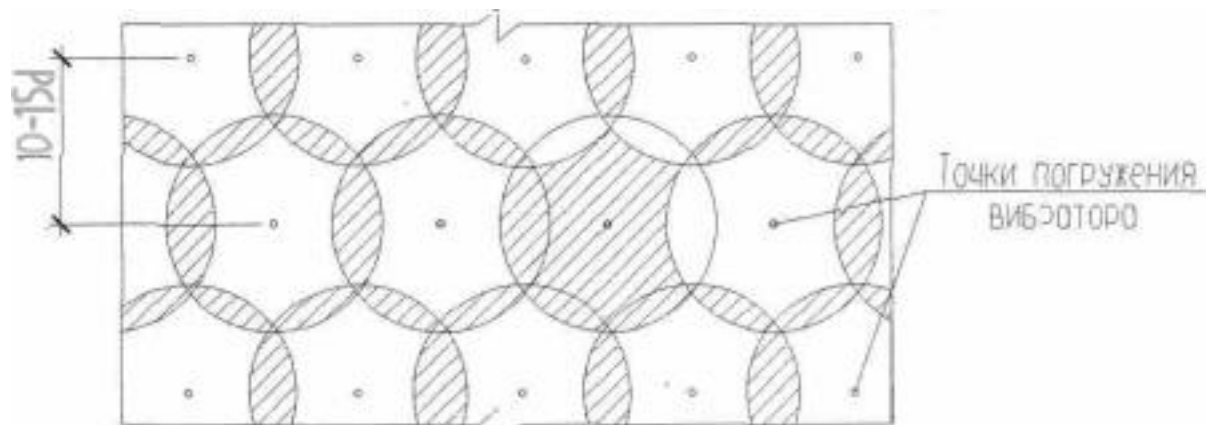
технологическая схема укладки бетонной смеси.
